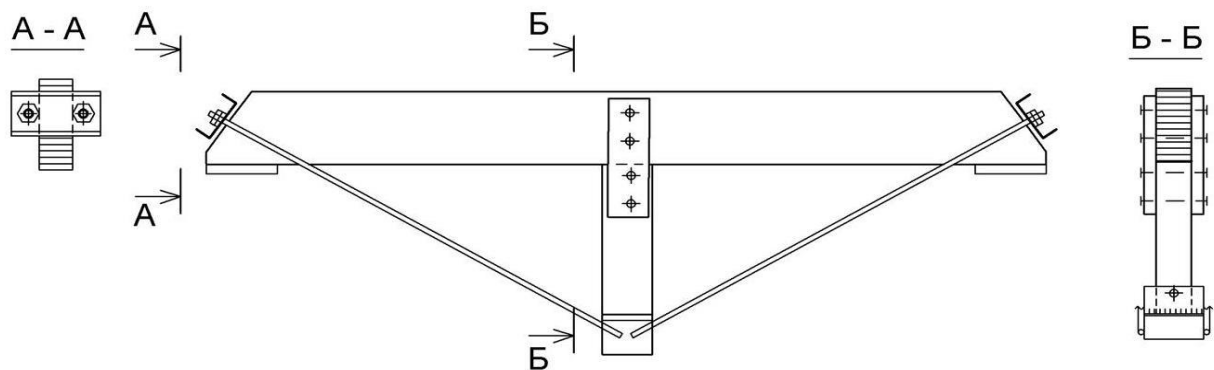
Усиление клееной деревянной балки с изменением расчетной схемы
